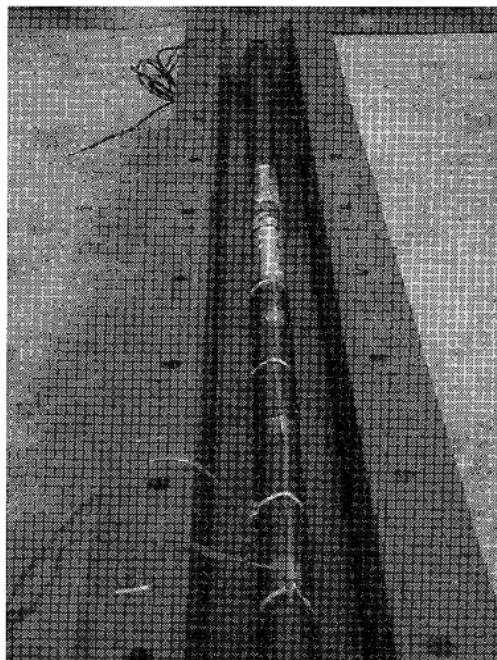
ひび割れ抵抗性試験型枠の概要
